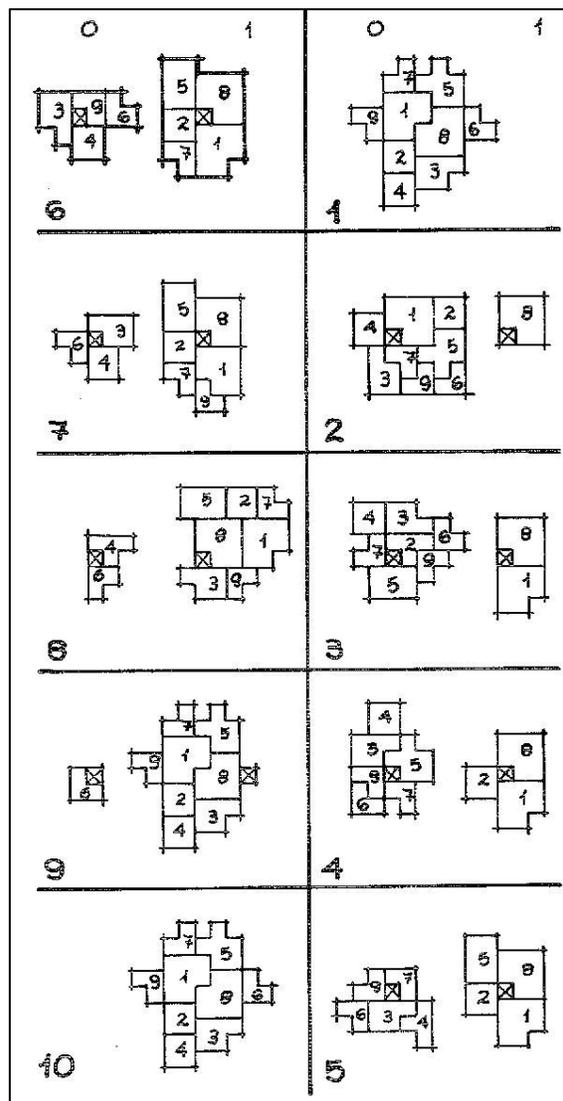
Layouts* alternativos com um ou dois pavimentos.
